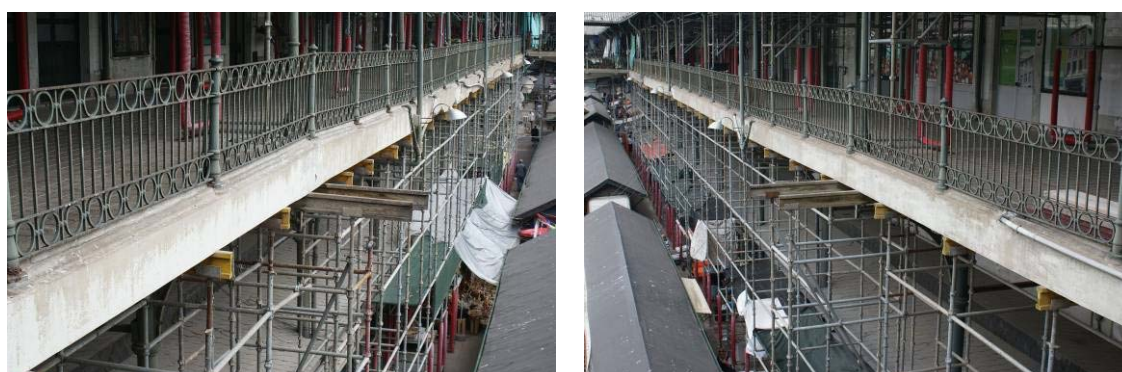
Deformação estrutural da galeria interior na zona sul do Mercado.
